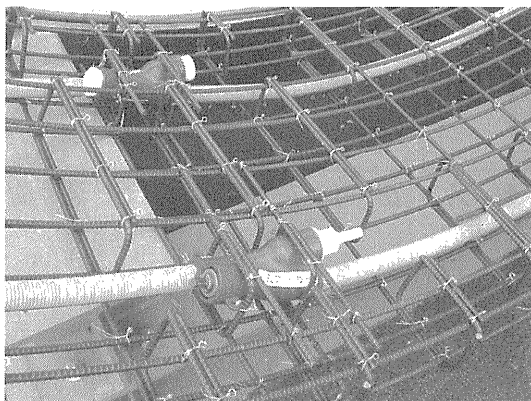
Xアンカー、鉄筋およびポリエチレンシースの配置
